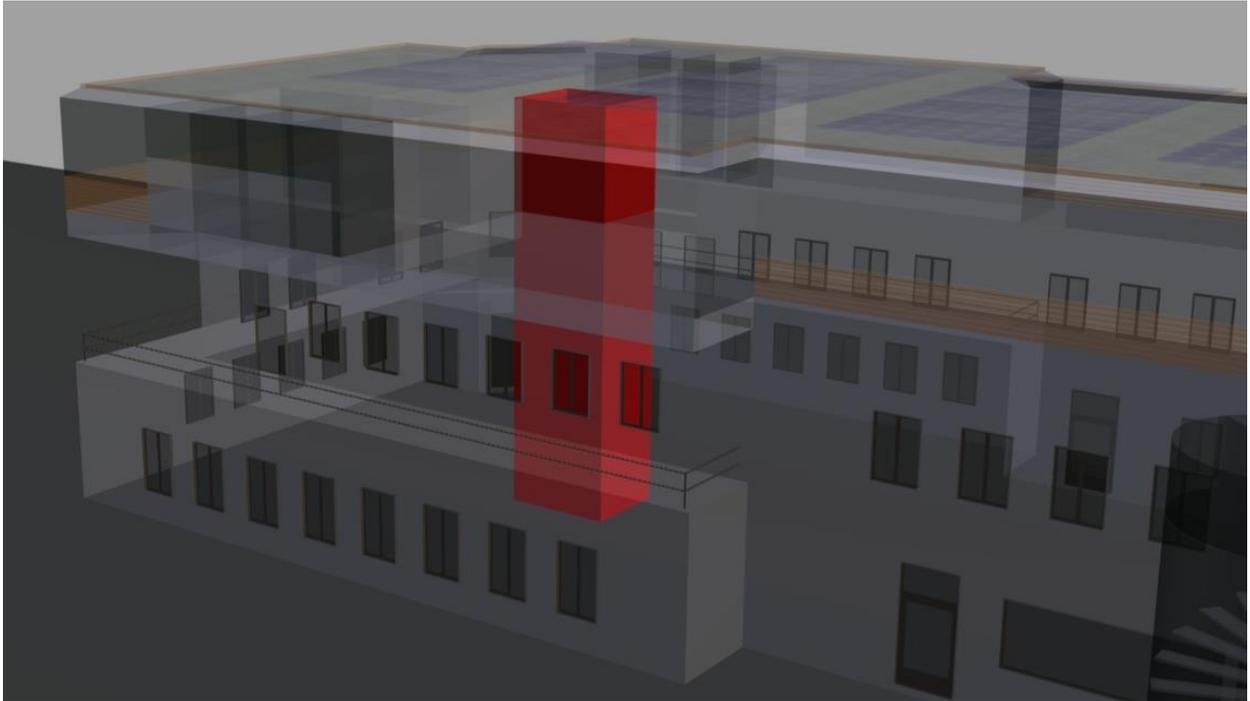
Haupthaus Aufzuganimation durch die bestehende Dachkuppel
